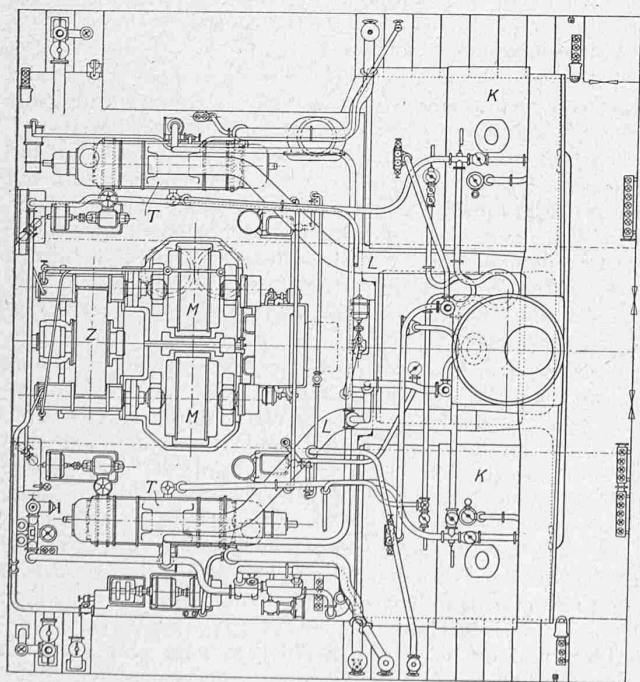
Grundriss des Maschinenraums. — 1:150.
